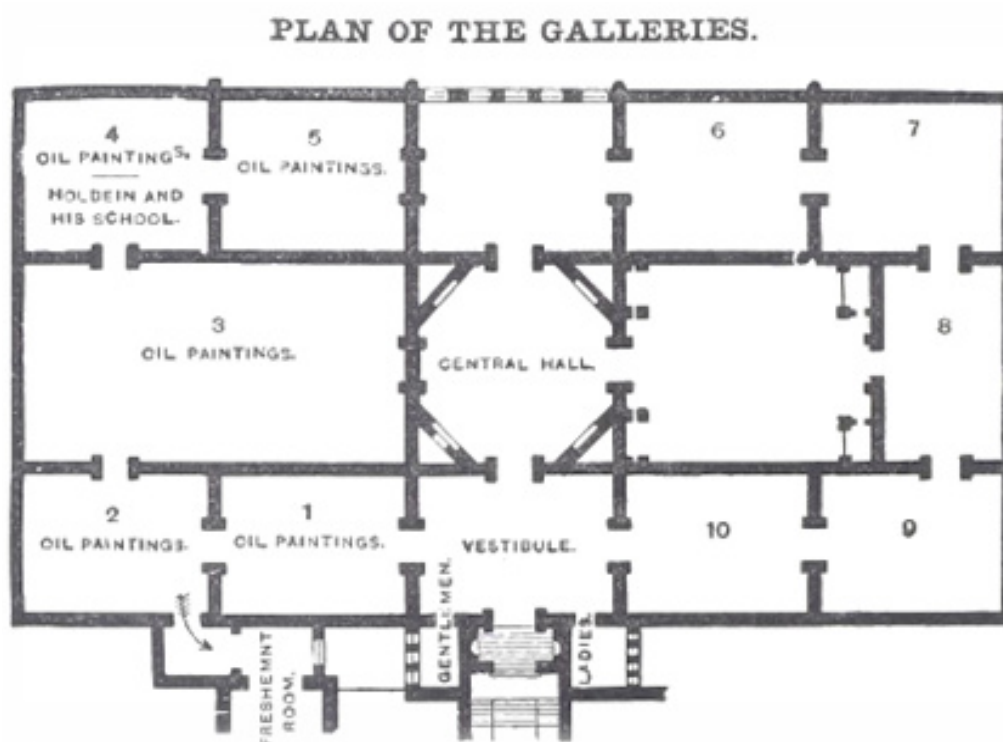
Planta de la galería número 5 de la Burlington House, Londres, 1880.
